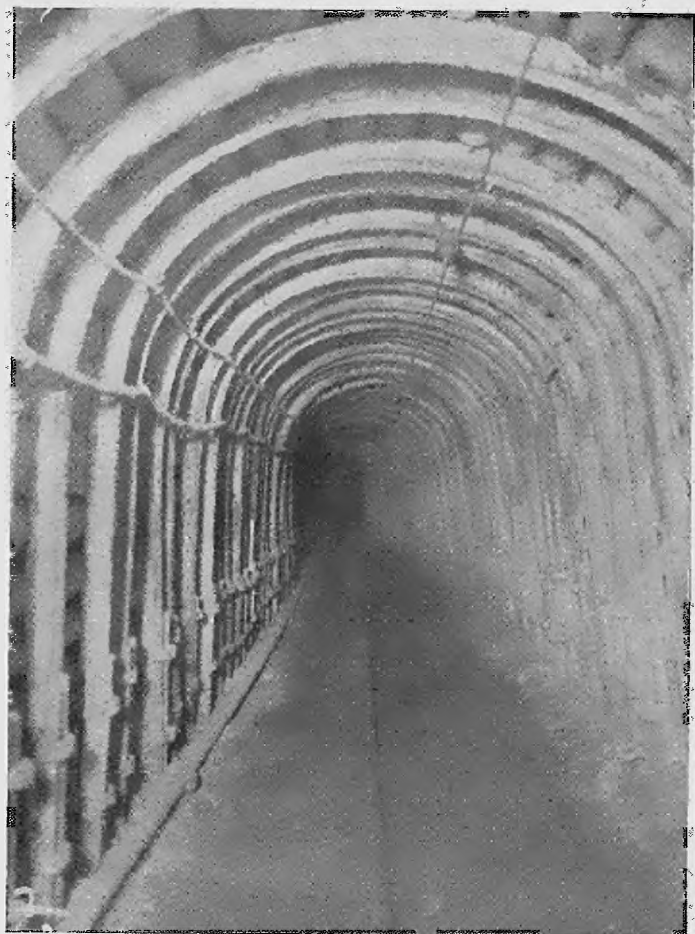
Nachgiebiger Streckenbogenausbau mit nachgiebigen Stempeln
